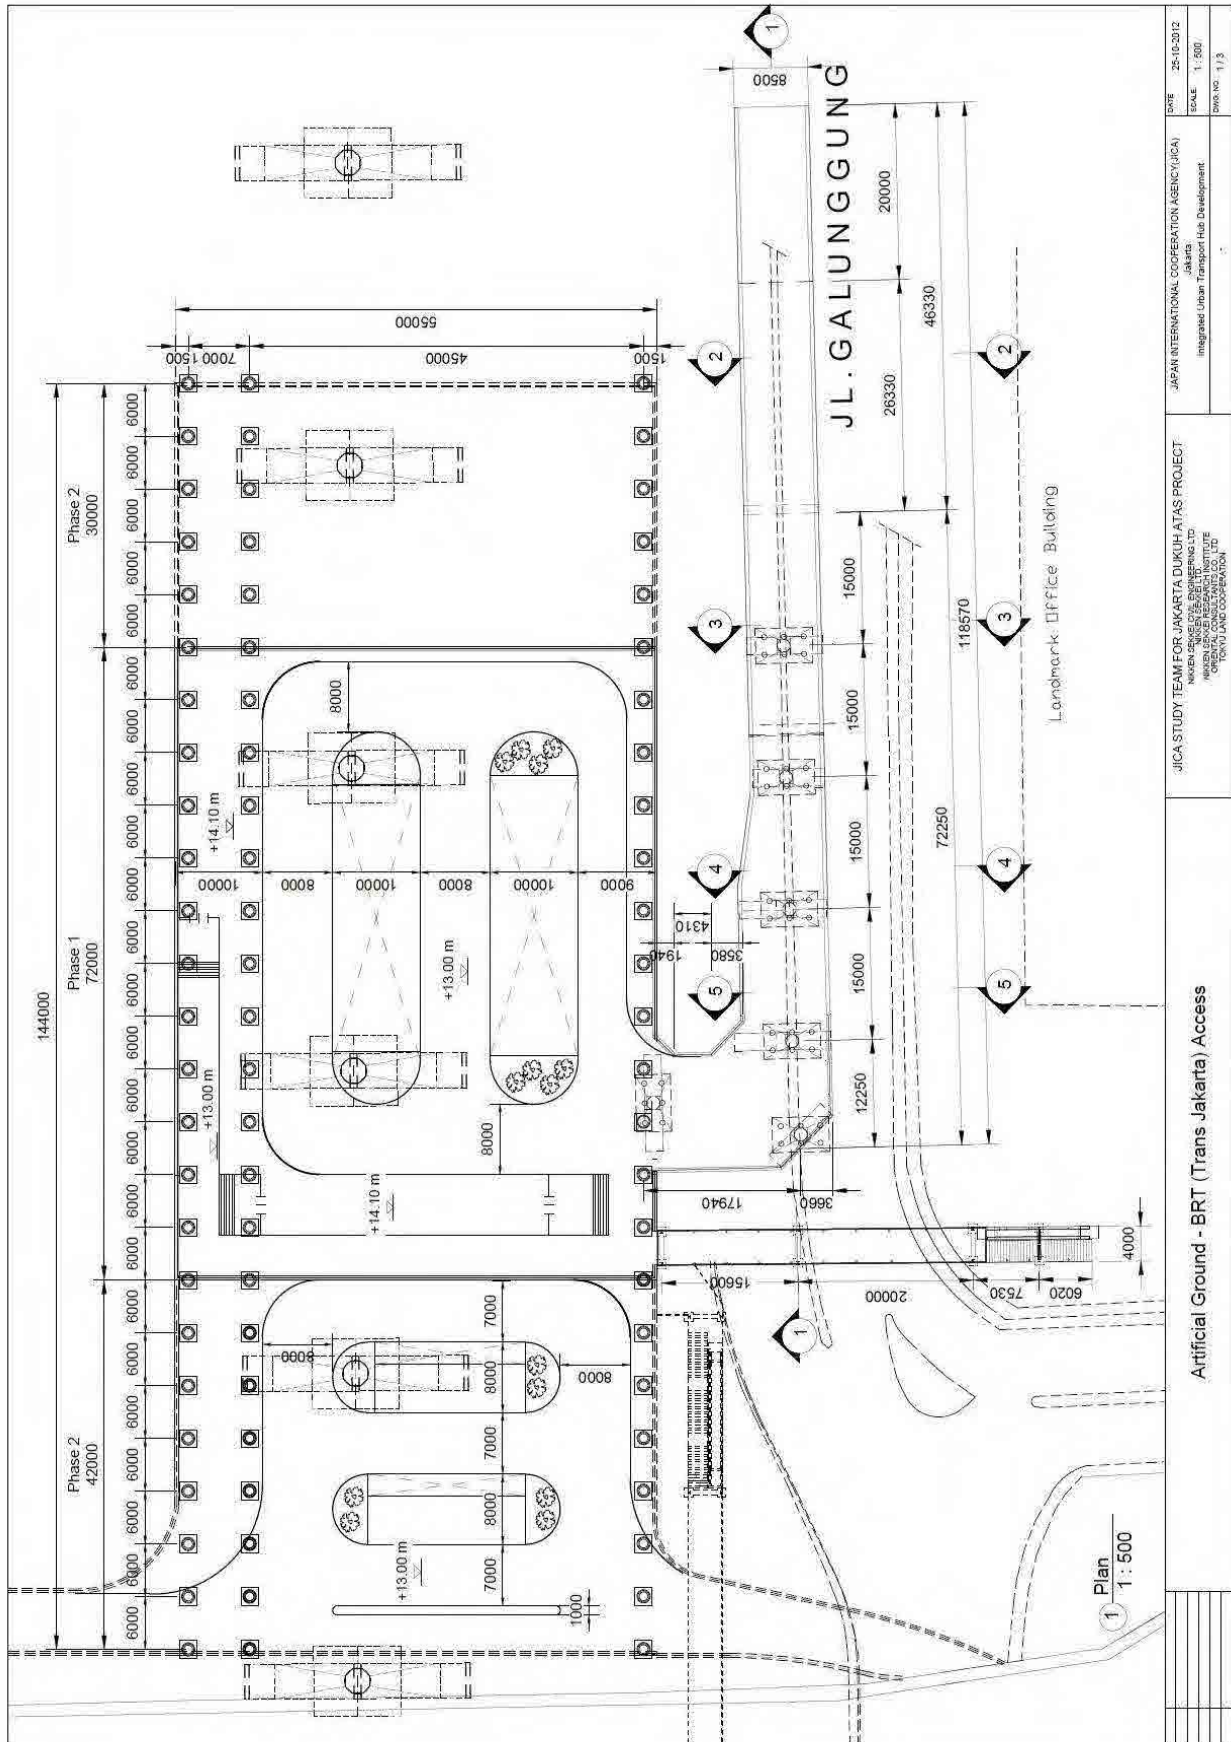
Phase-1 部分平面図 (出典：調査団)
